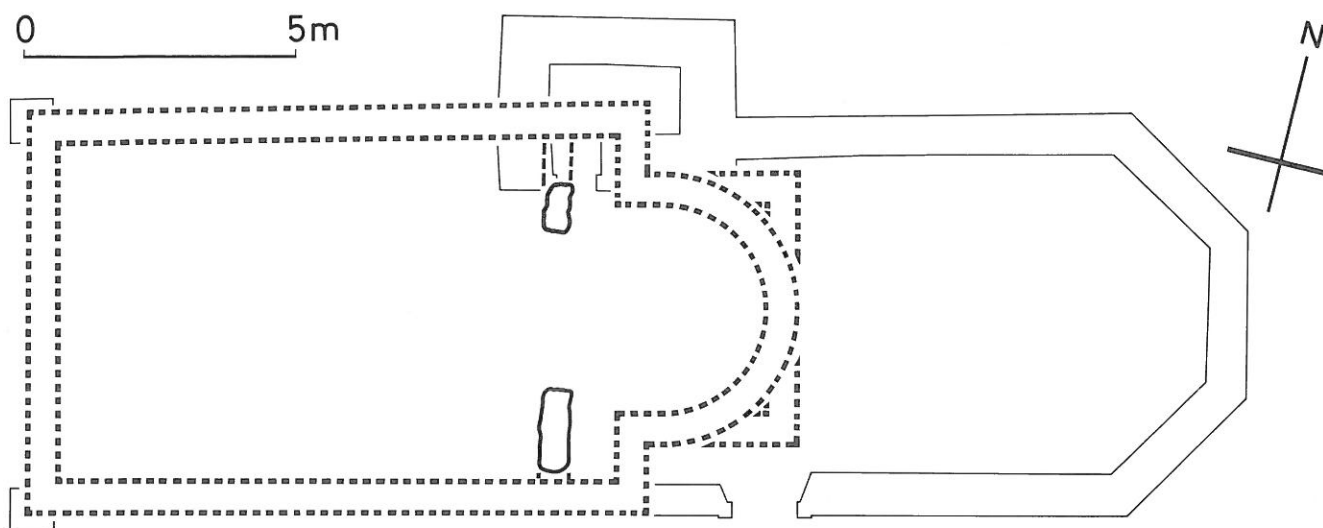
Rekonstruierter Grundriss der Anlage II. M. 1:140
